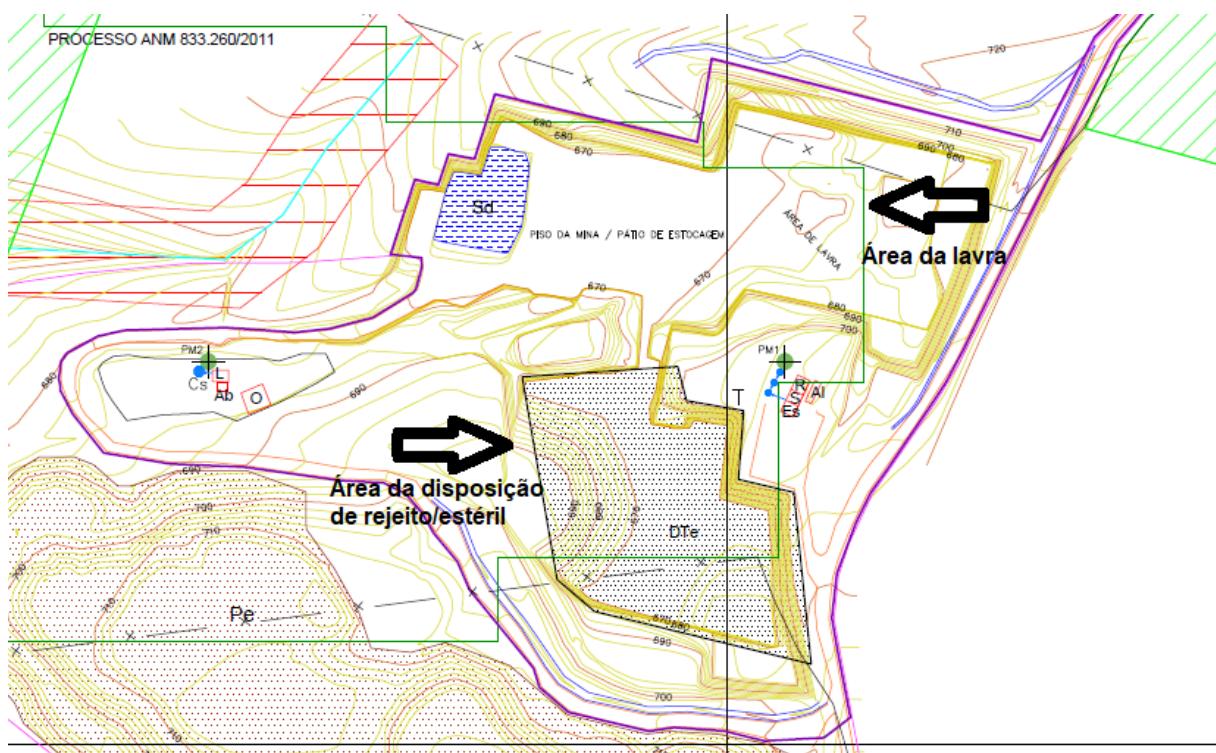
Localização das áreas da lavra e da pilha a ser construída.
